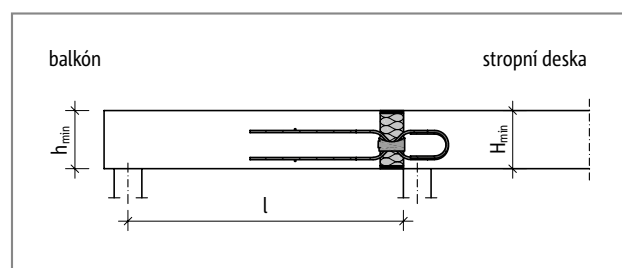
Schöck Isokorb® T typ QP-V1 a QP-V3: Statický systém
